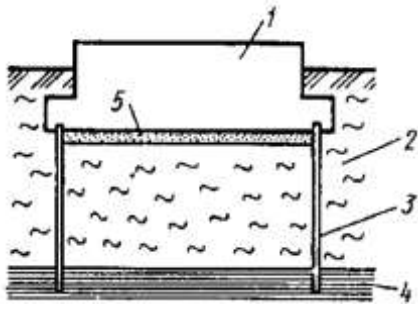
Посилення основи за допомогою шпунтової огорожі: 1 – фундамент; 2 – слабкий ґрунт; 3 – шпунтова огорожа; 4 – щільний ґрунт; 5 – піщана подушка (дренуючий шар).
